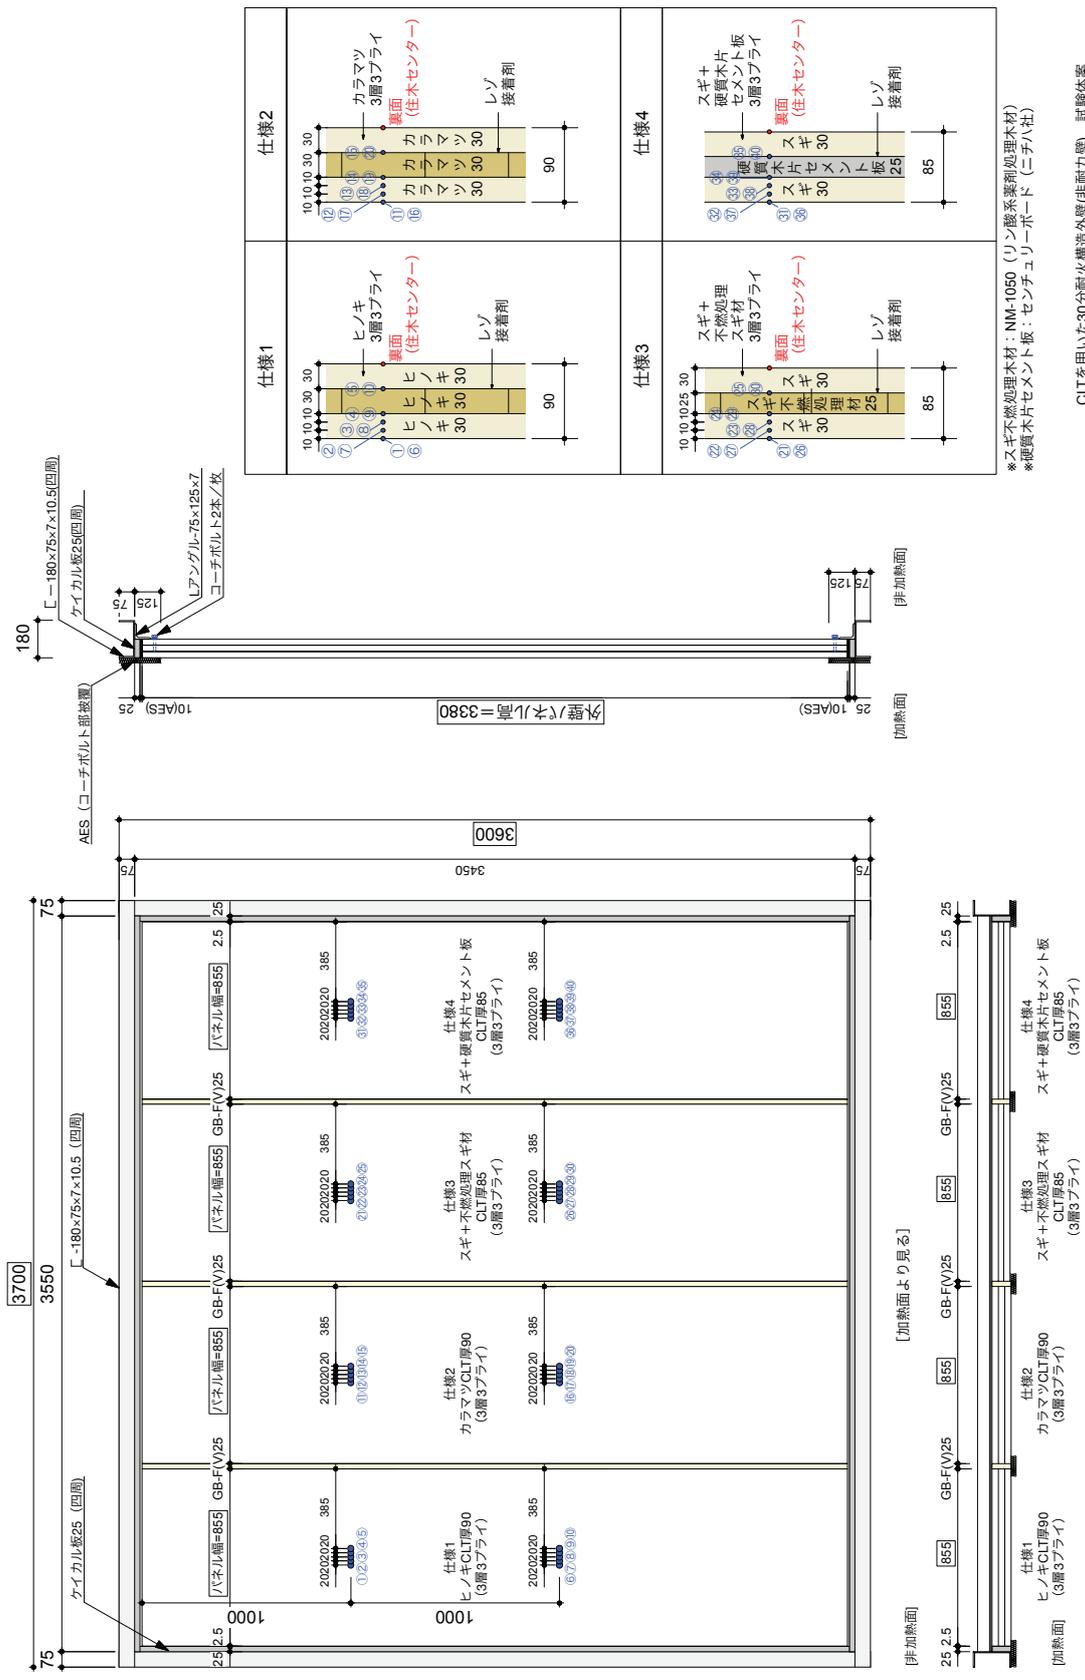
試験体1の構造・寸法・熱電対配置 (単位: mm)
